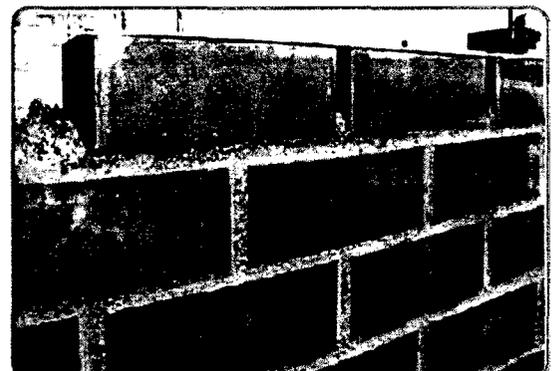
a. Ladrillo artesanal en muro de albañilería
